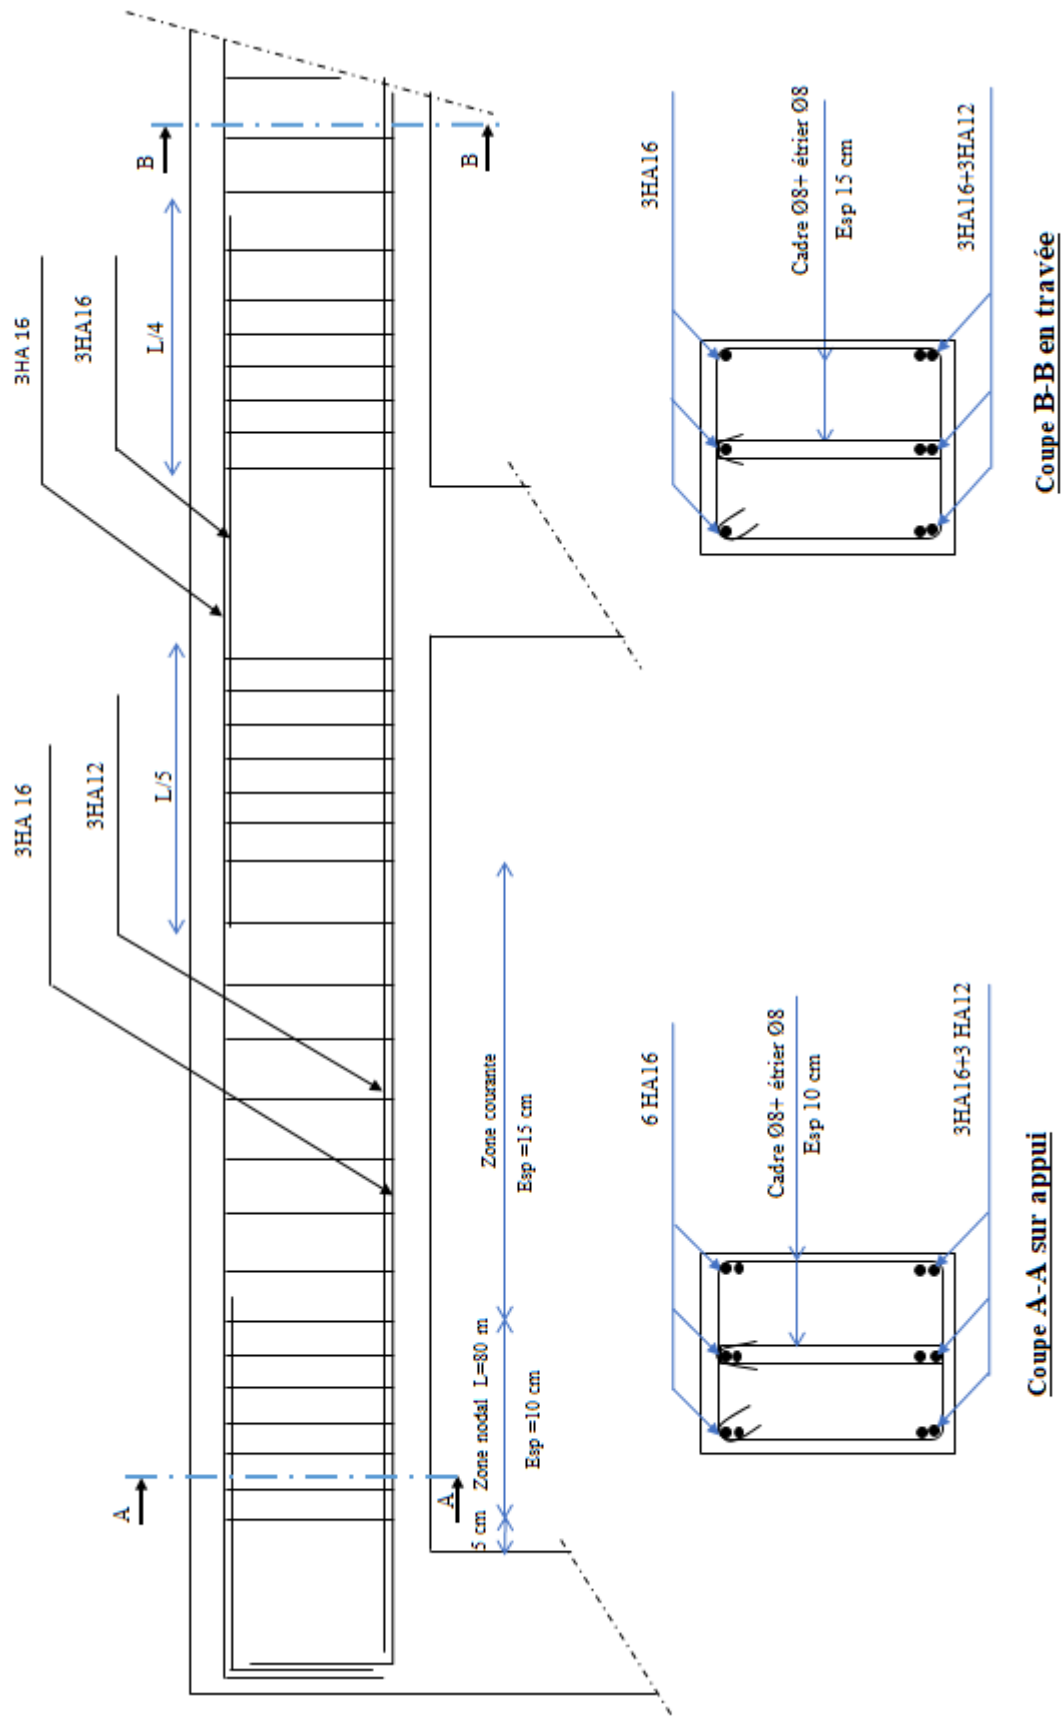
Schéma de ferrailage du poutres principales
